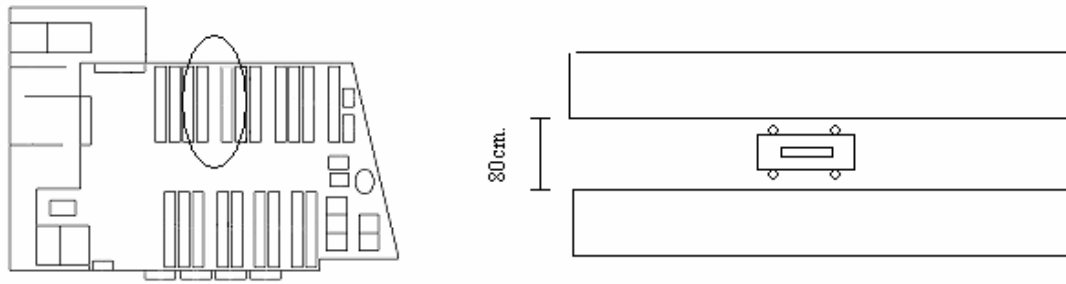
Izquierda: Layout del almacén. Derecha: dimensiones de pasillo entre andenes
